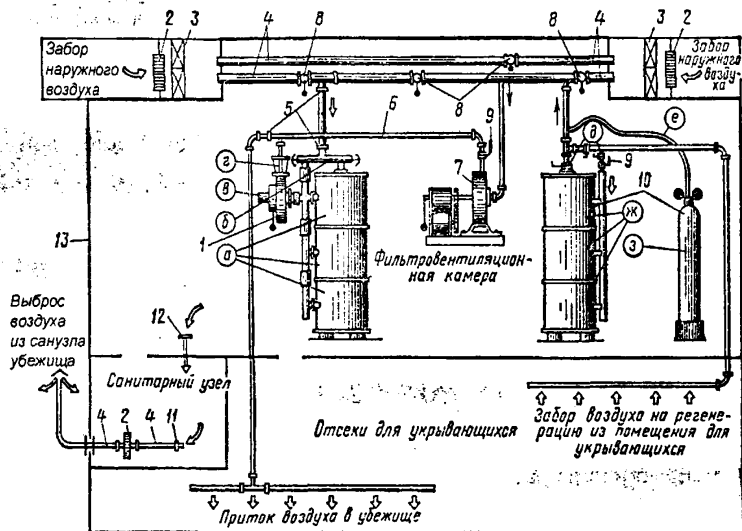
Принципиальная схема воздушноснабжения убежища с фильтровентиляционным оборудованием старого образца
